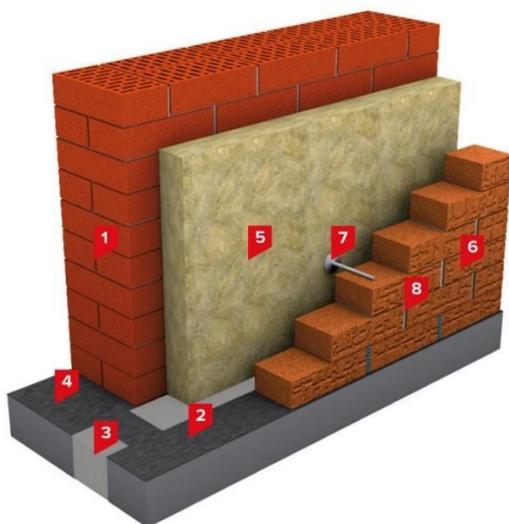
Конструктивное решение наружной стены с утеплителем из каменной ваты:
